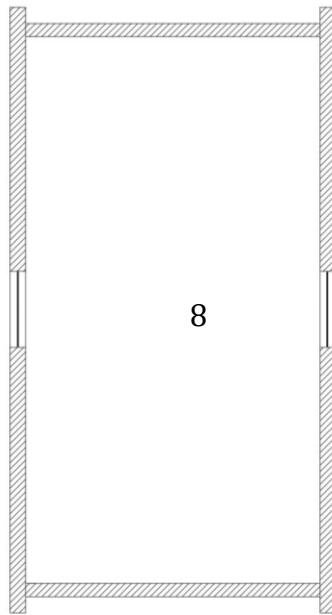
Planta original, Piso 3, Fonte: Autor
